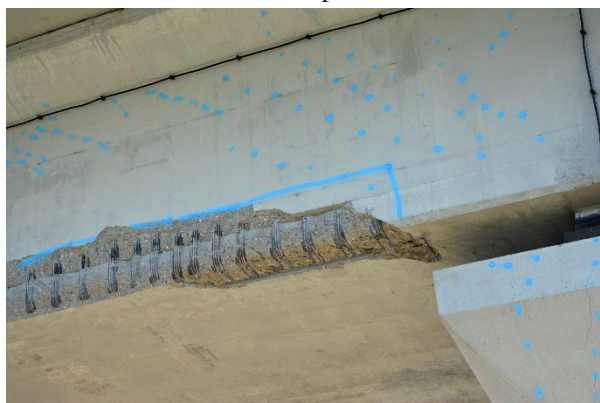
Pérdida del recubrimiento de hormigón en el vano 3 junto a la pila 2
